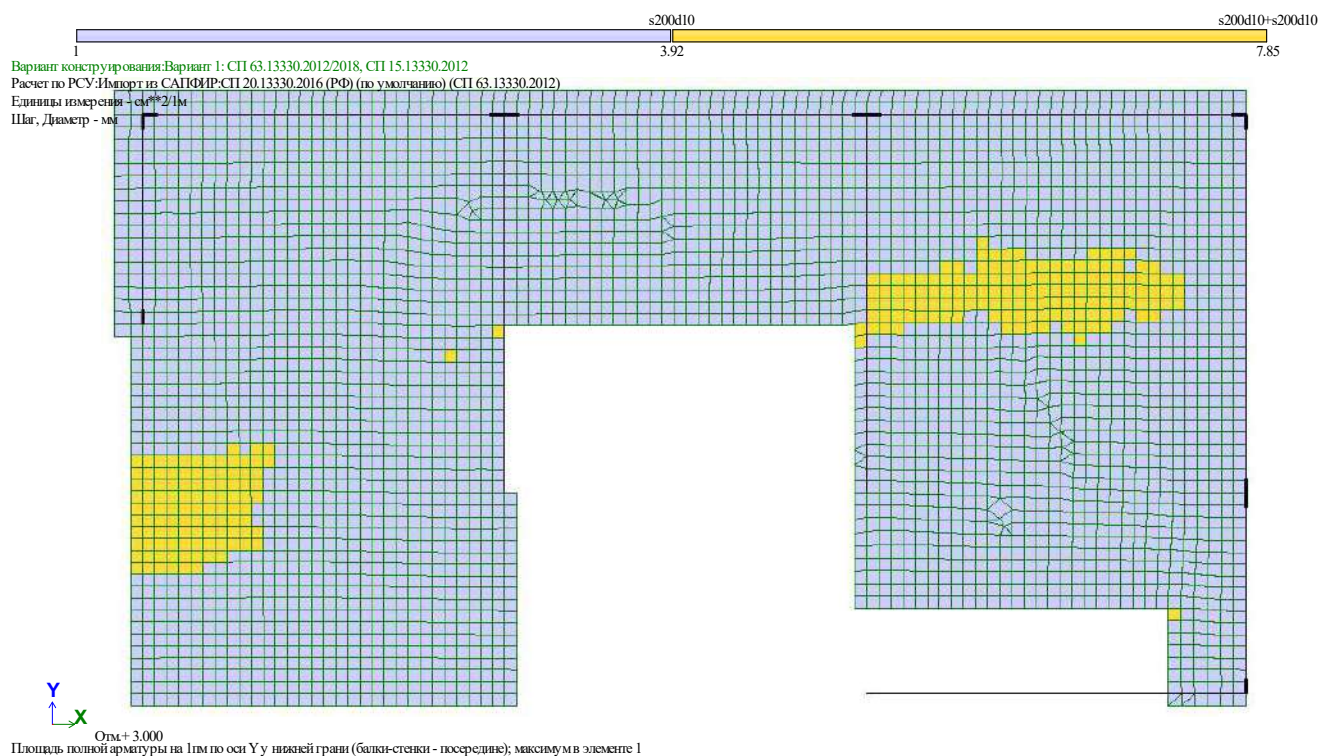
Мозаика армирования нижней арматуры вдоль ц.о.
